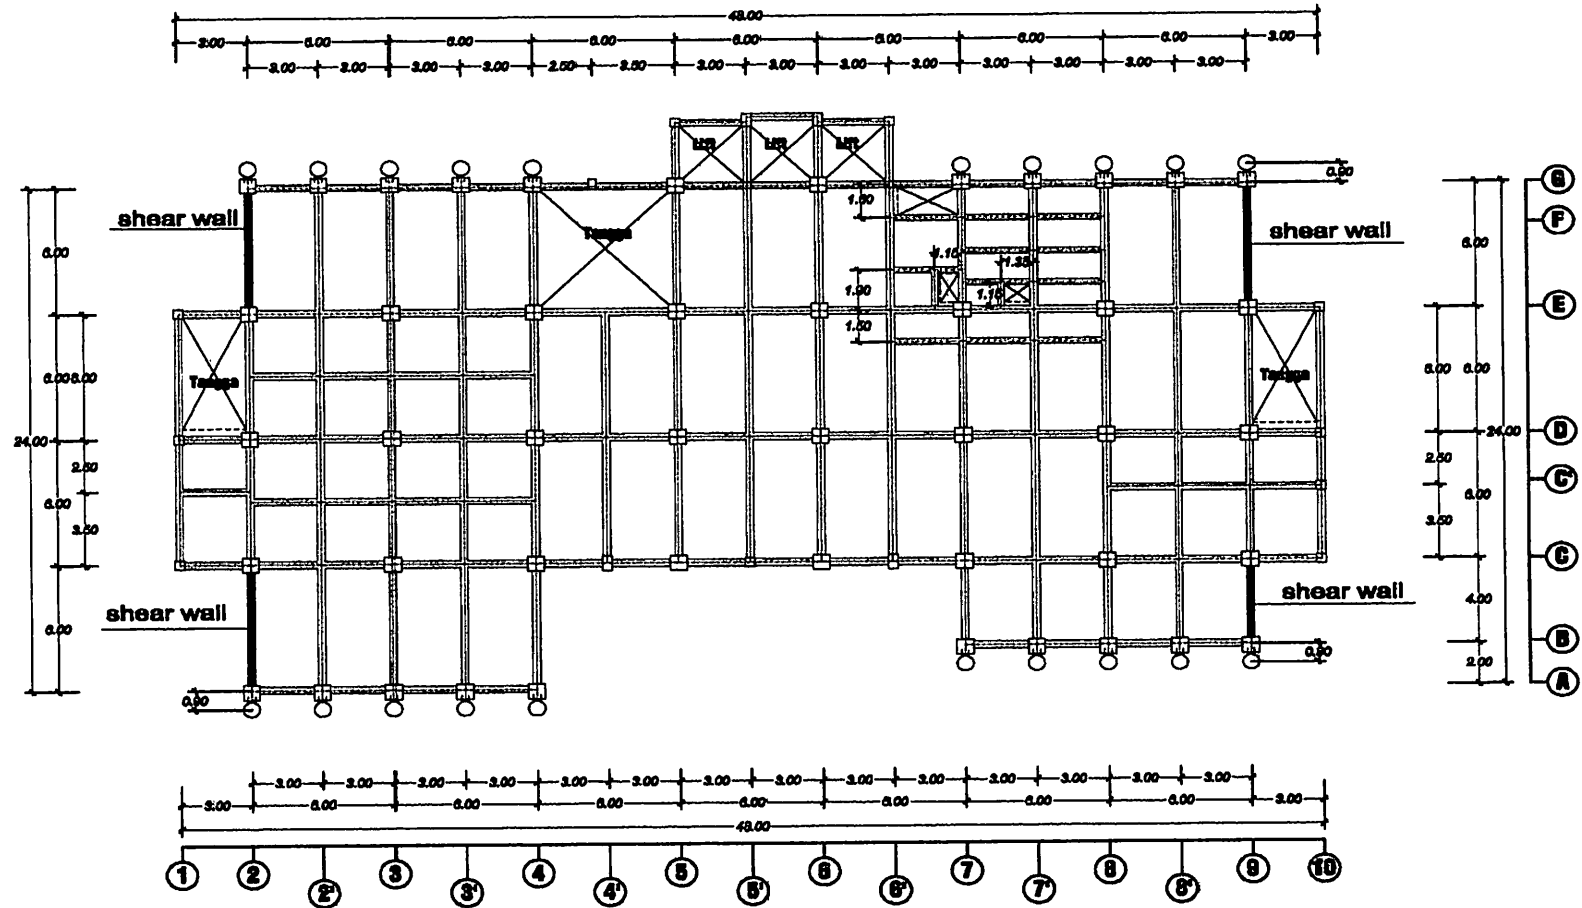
Denah Balok Dan Kolom Lt 3
